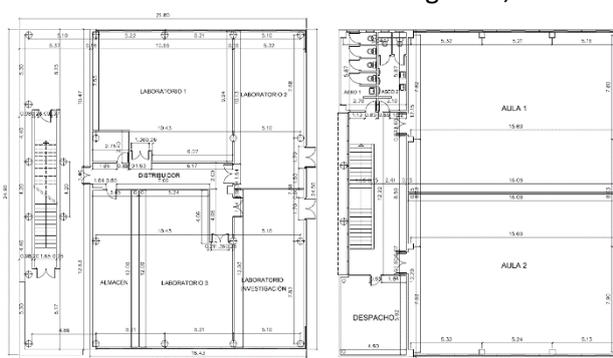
Plantas de estado actual tras segunda investigación. (Planimetría facilitada por un alumno compañero de la escuela).
